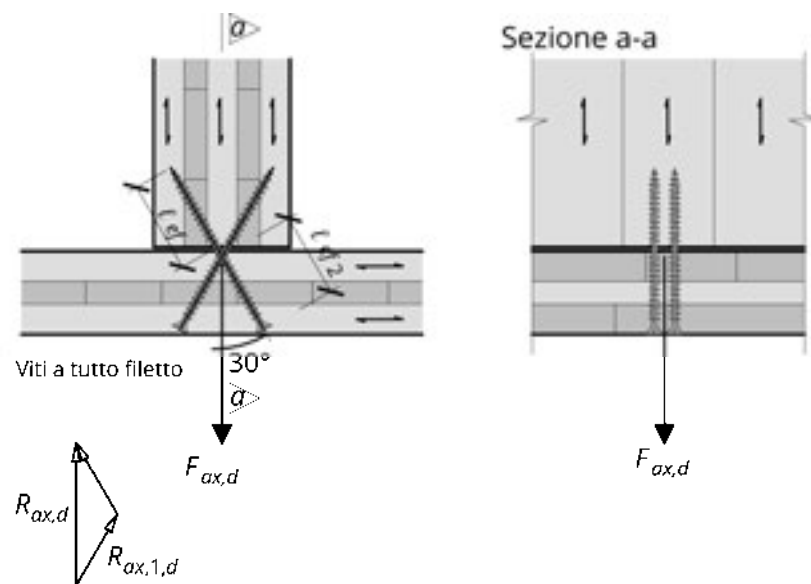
\* Sospensione tramite viti a tutto filetto parallele al piano della parete
